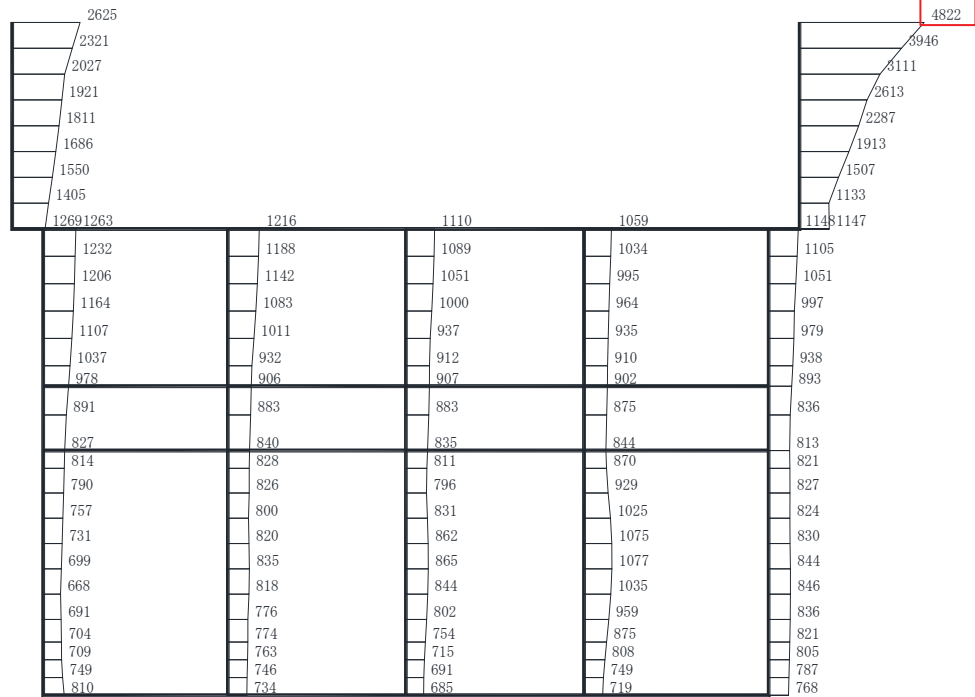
(3) 海水ポンプ室断面図 (補機ポンプエリア) (B-B 断面)
